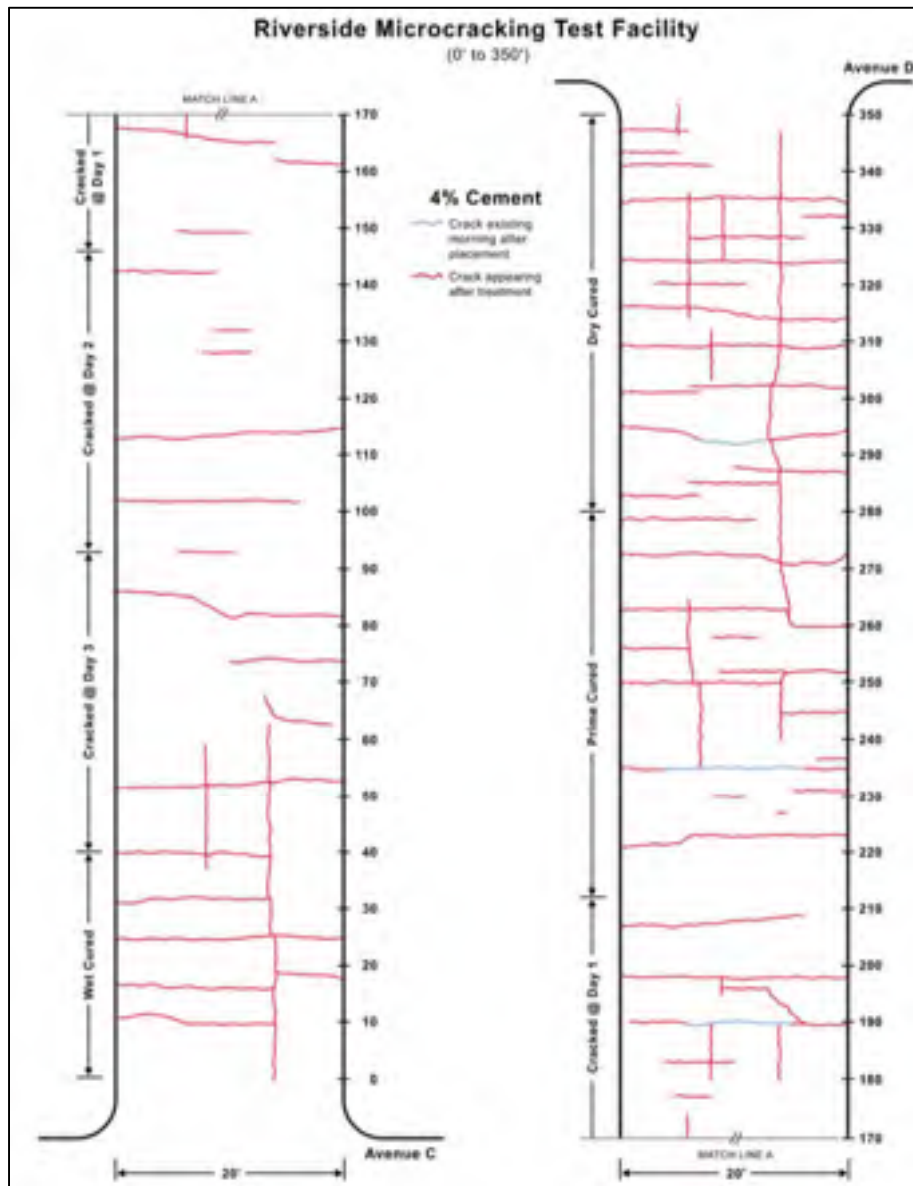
Plan de la fissuration pour section à 4 % (Sebesta, 2005)
